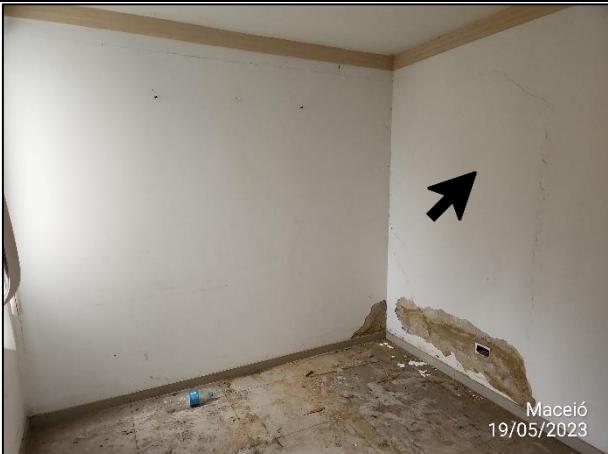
Detalhe da fissura – 0,2 mm – Depósito 02 – Bloco C
